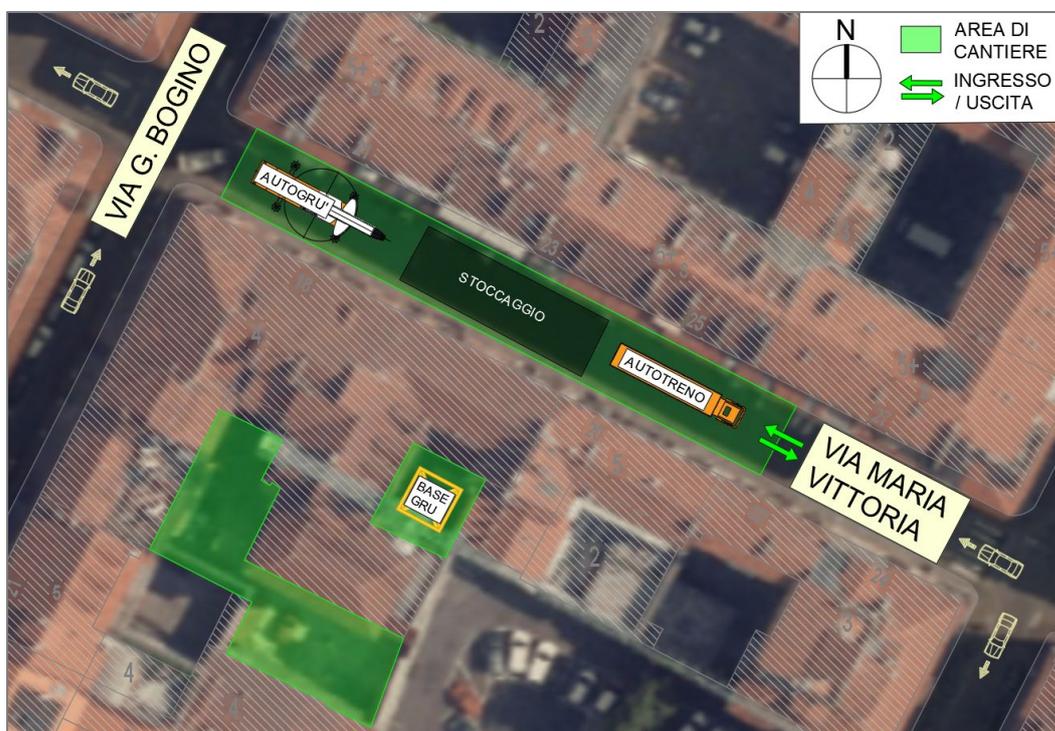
Configurazione del cantiere su via Maria Vittoria
